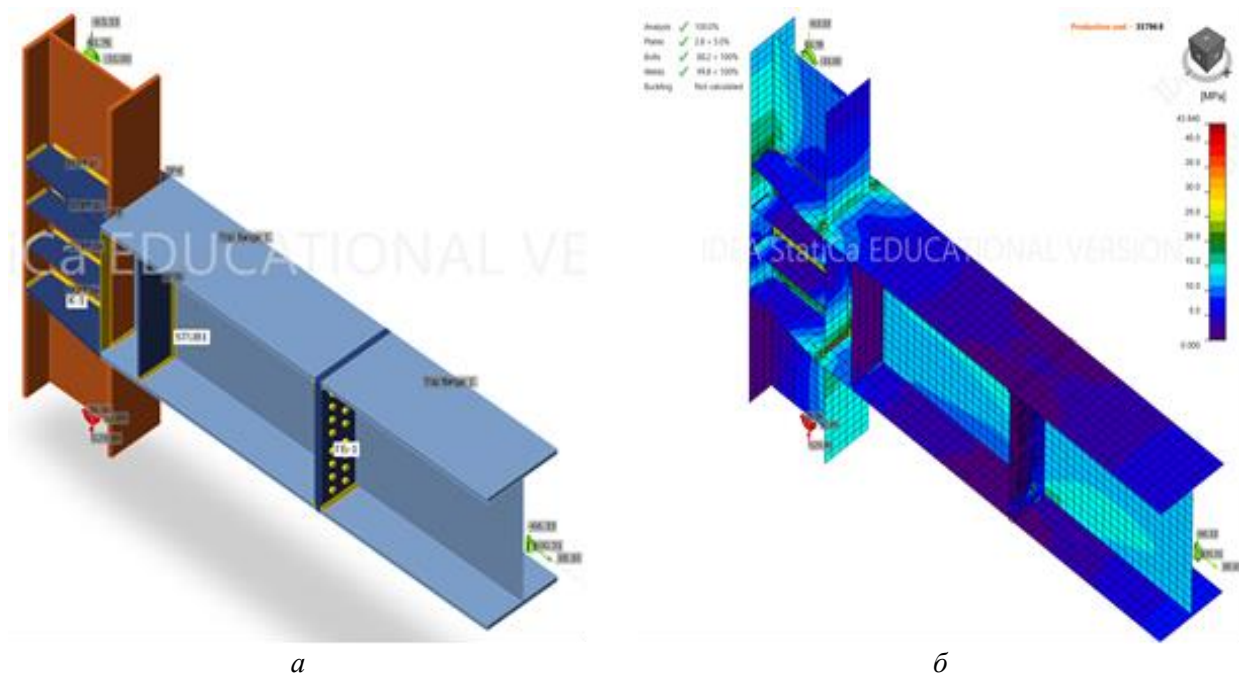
Вузол з'єднання балки та колони: а – модель; б – НДС вузла
